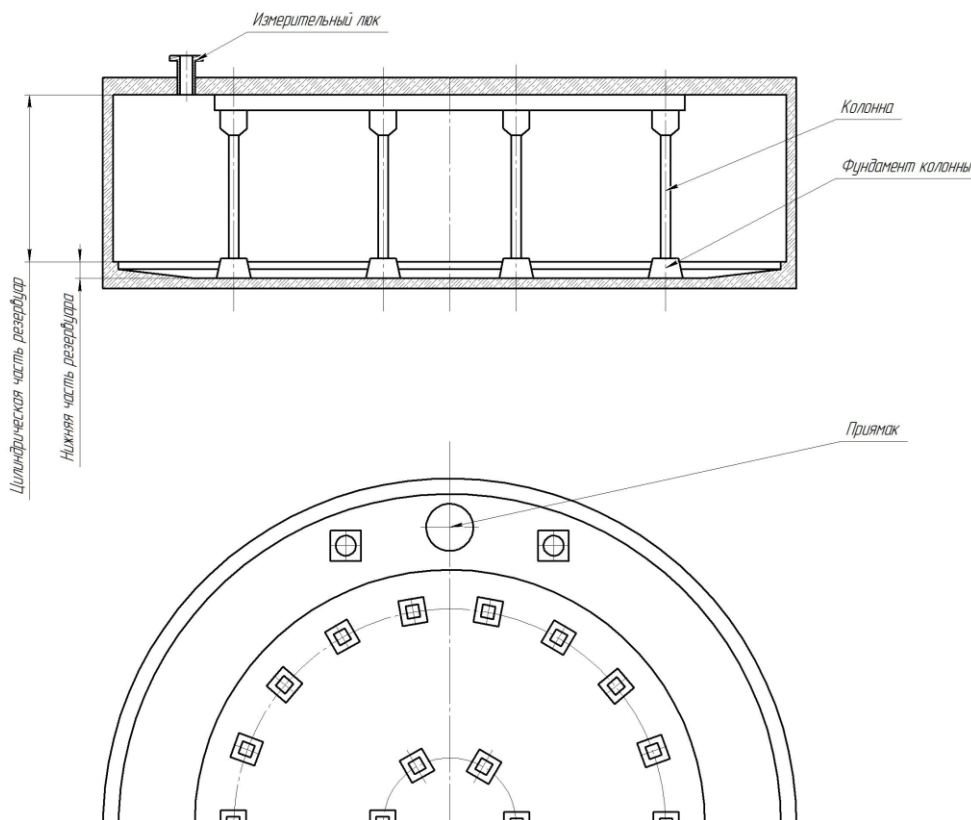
Общий вид эскиза резервуаров ЖБР-30000
